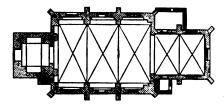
Poseritz. Kirche. Grundriss. 1:667.
